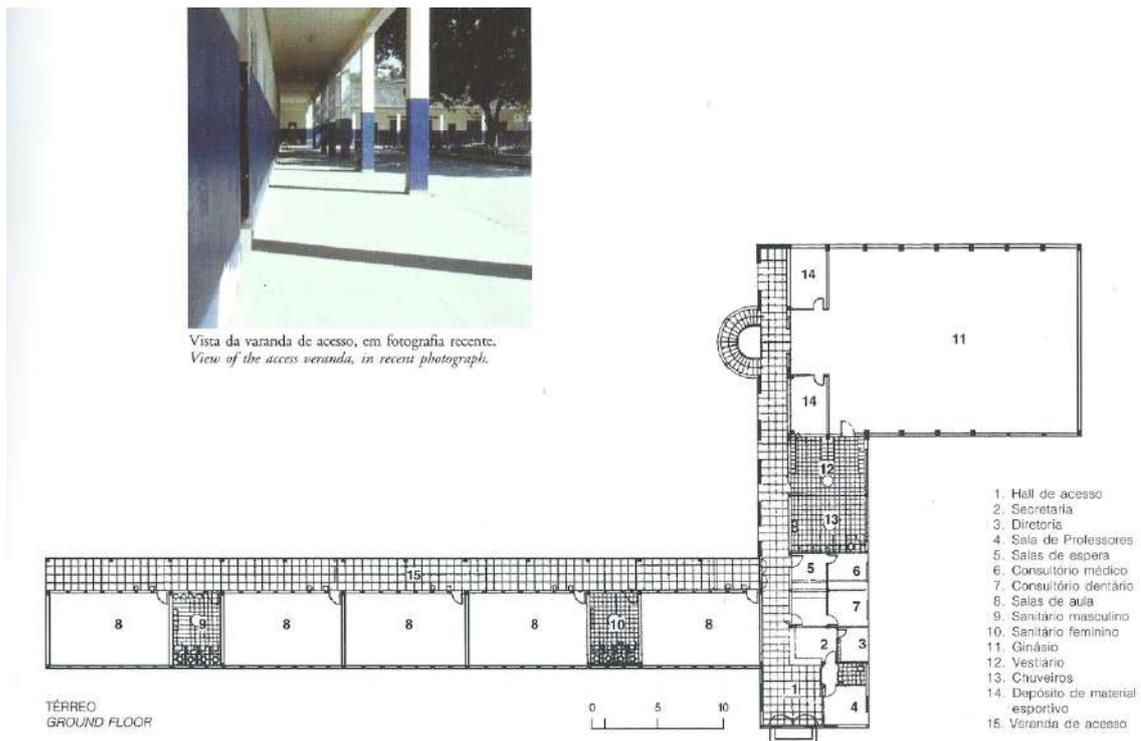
Planta Baixa do projeto da Escola Rural Coelho Neto
